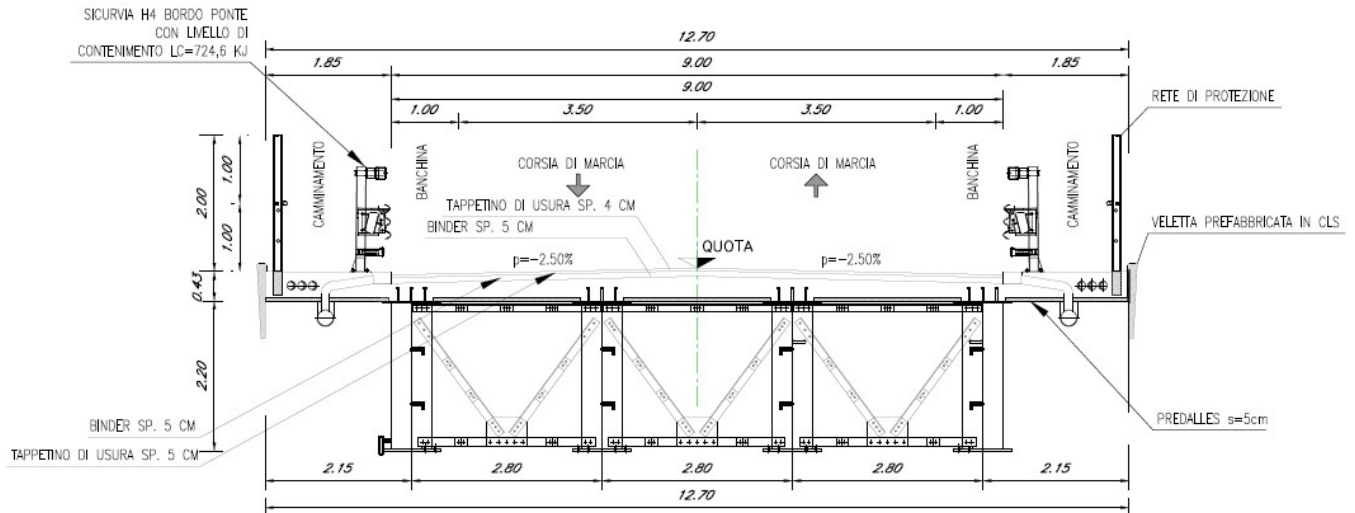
Sezione trasversale tipo dell'impalcato L=40m e L=55m
